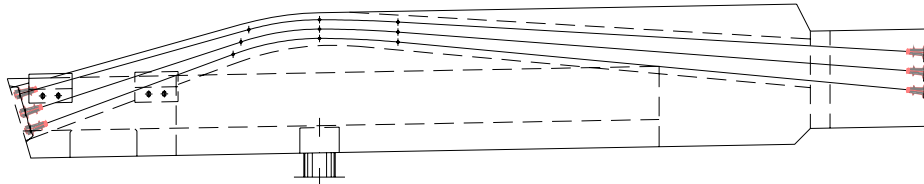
Traçado esquemático do pré-esforço instalado nas vigas principais
